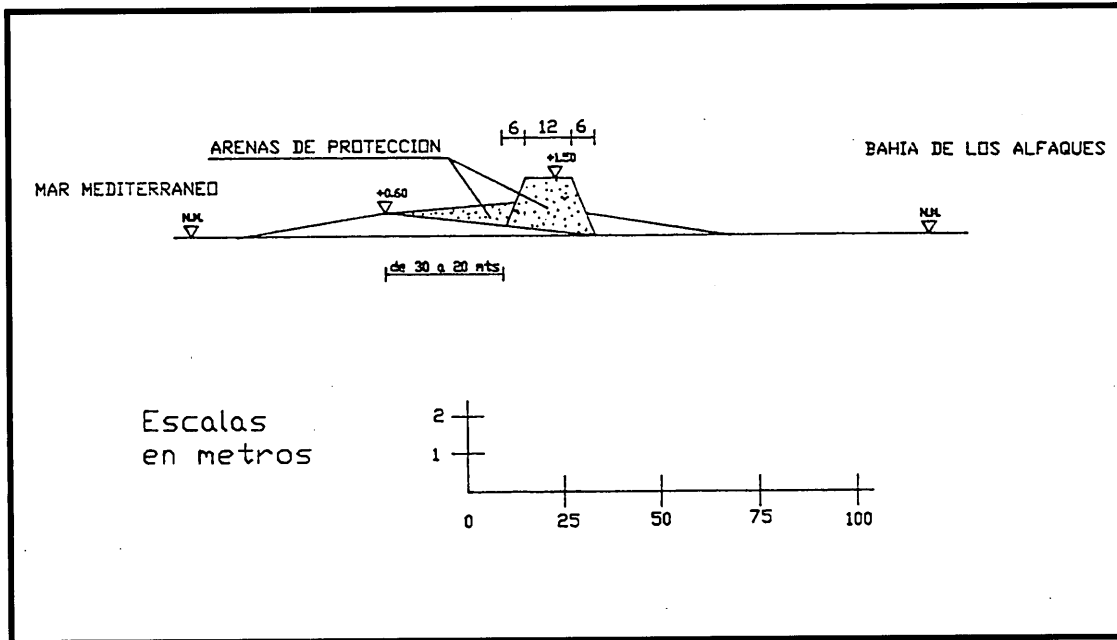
a). Perfil tipo de proyecto de la duna construida en la barra del trabucador.
